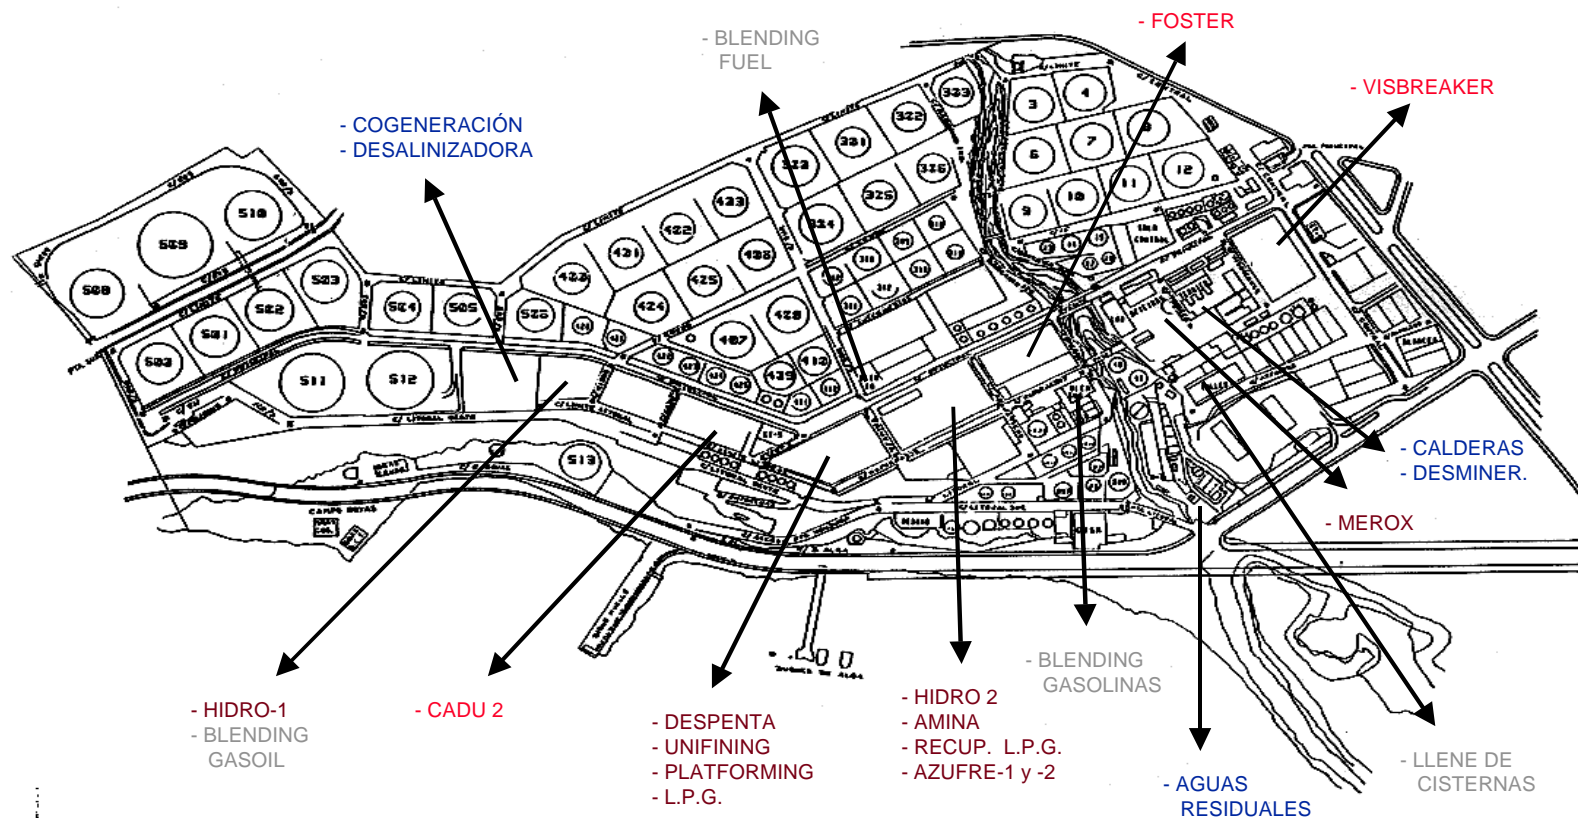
Plano de la Refinería Tenerife, (CEPSA, 1996).
